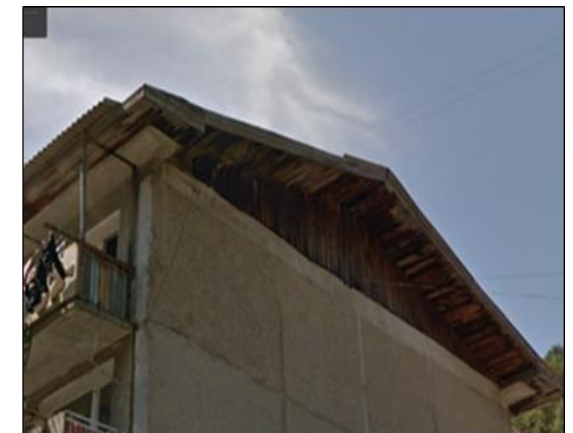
А.4 Фасад по ул. Гудина, А.4 - Состояние кровли
